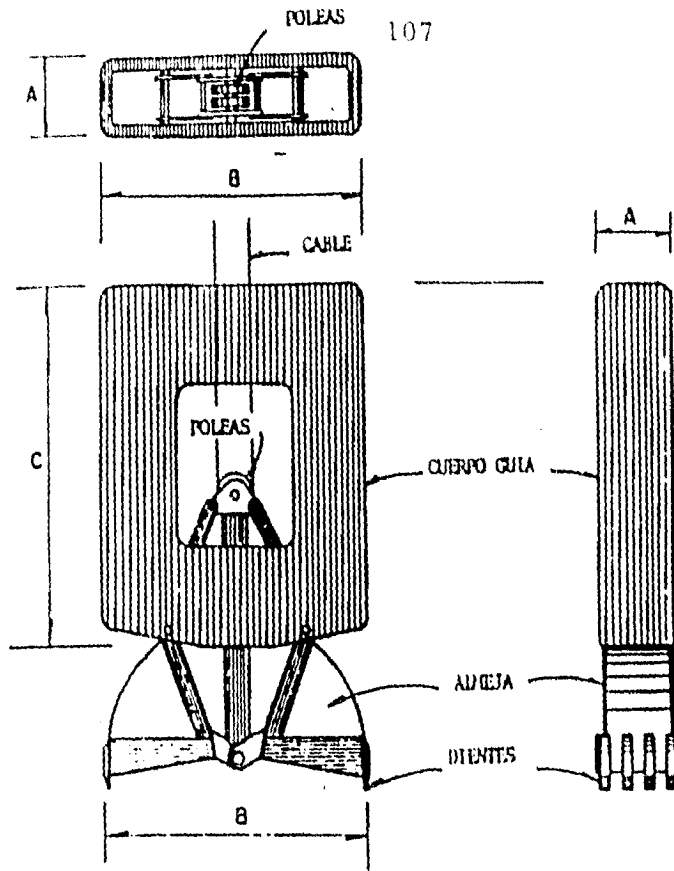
ALMEJA LIBRE OPERADA POR CABLES.
